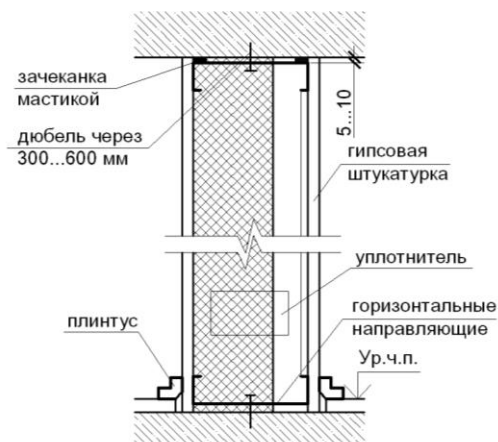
Вертикальное сечение по каркасной перегородке
